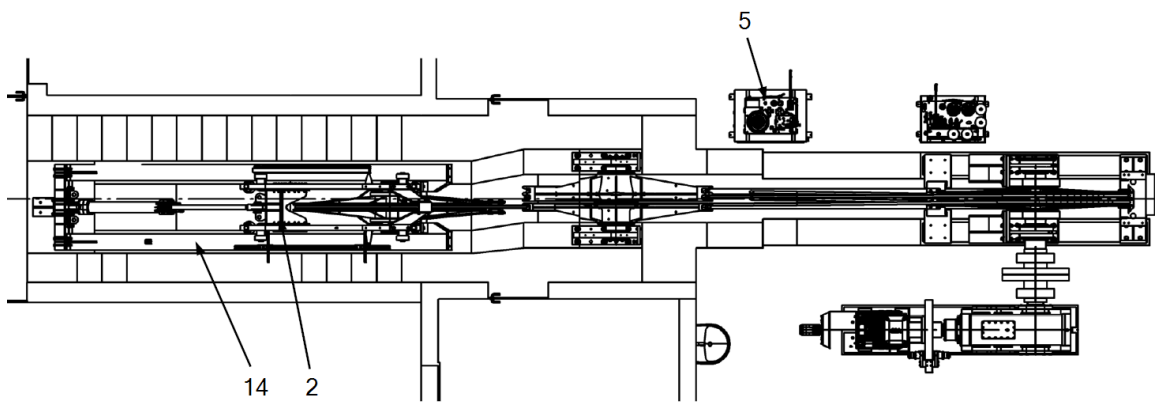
Grundriss Maschinenraum in der Bergstation
